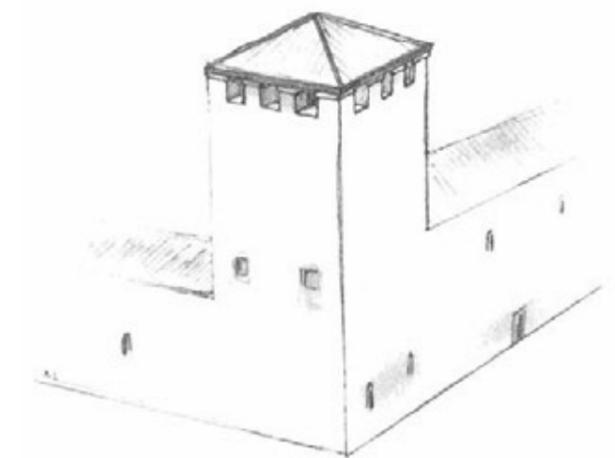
Propuesta de reconstrucción morfológica de la torre sudeste en el siglo XVI. Vista de los alzados oriental y meridional. Elaboración: Alejandro García Álvarez-Busto.
